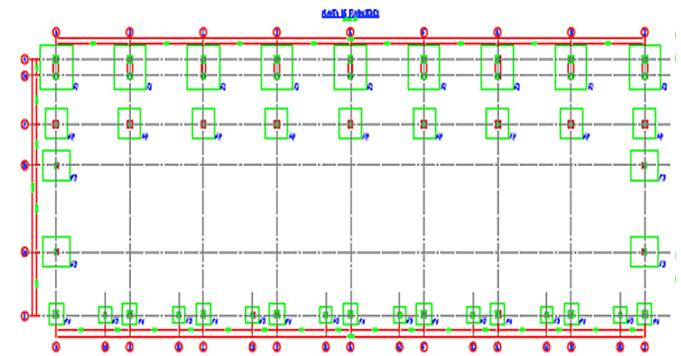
Planta de fundaciones Galpón-bodega Ruta 150 Penco-Lirquén
